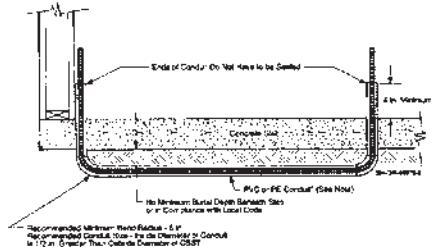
Installation dans un conduit non métallique sous une dalle
